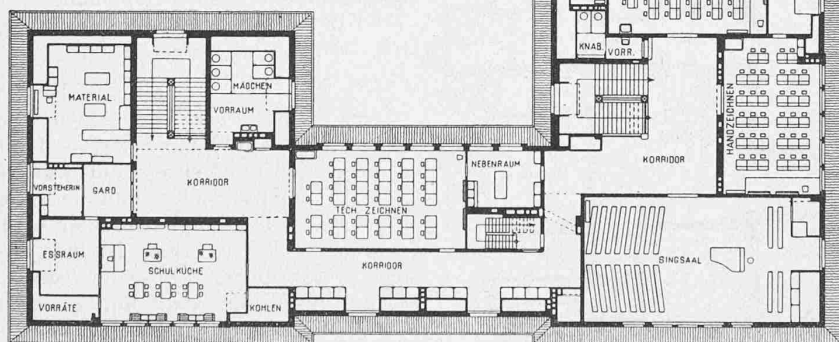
und 5. Grundrisse vom Erdgeschoss und vom Dachstock. — Masstab 1:500.
